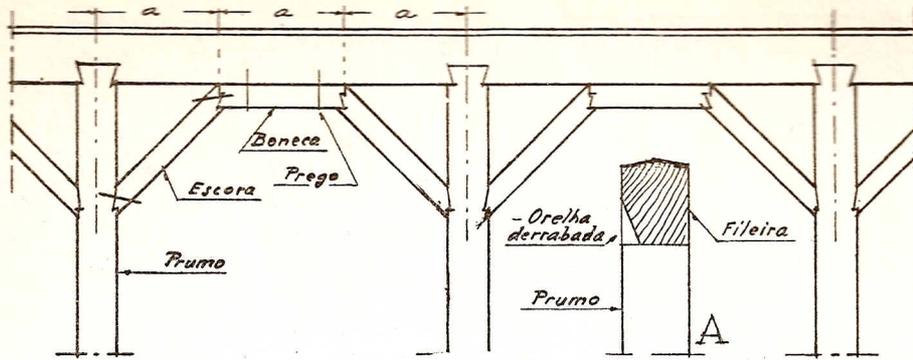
CONTRAVENTAMENTO CONSTRUÍDO COM BONECAS
